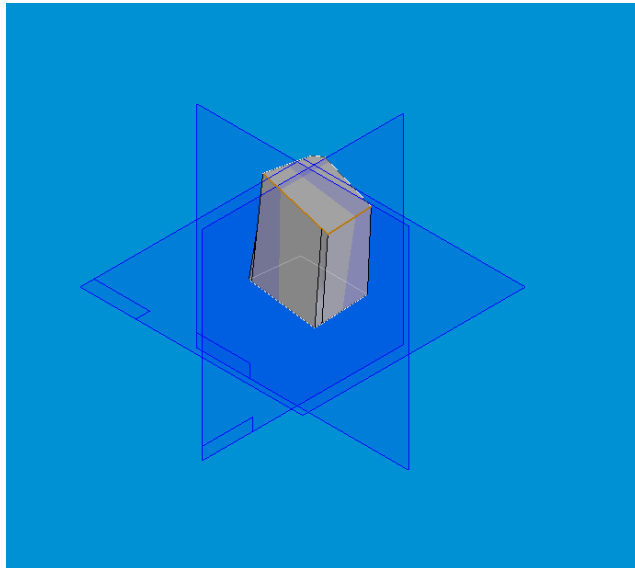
Ricostruzione geometrica del pilastro 26.
